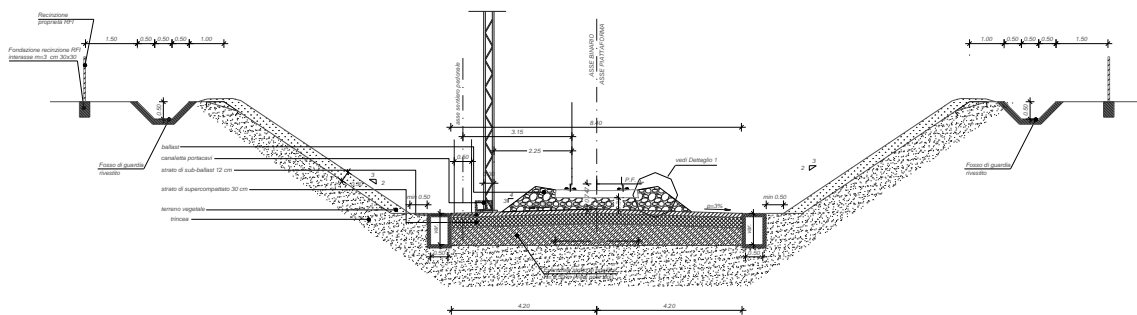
Sezione tipo ferroviaria in trincea a singolo binario in rettilineo
